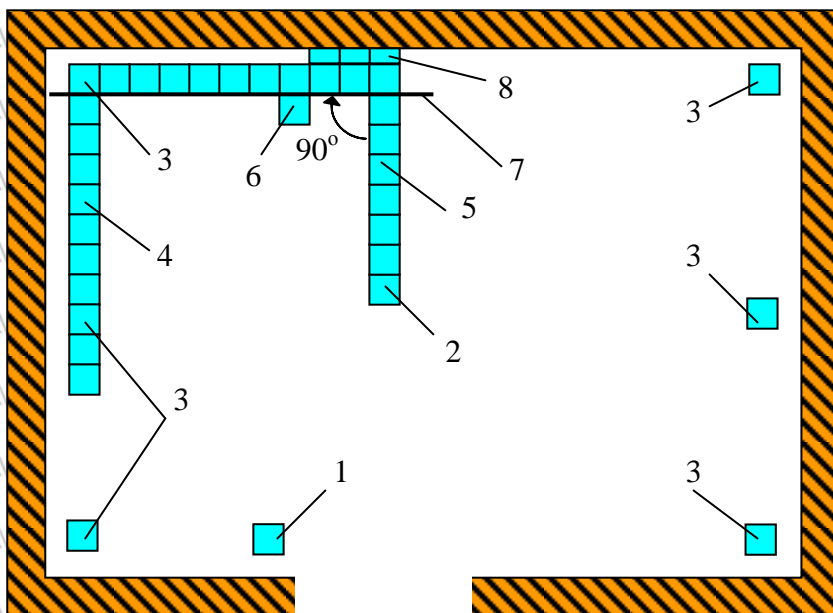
Разбивка пола для настилки плиток без фриза
